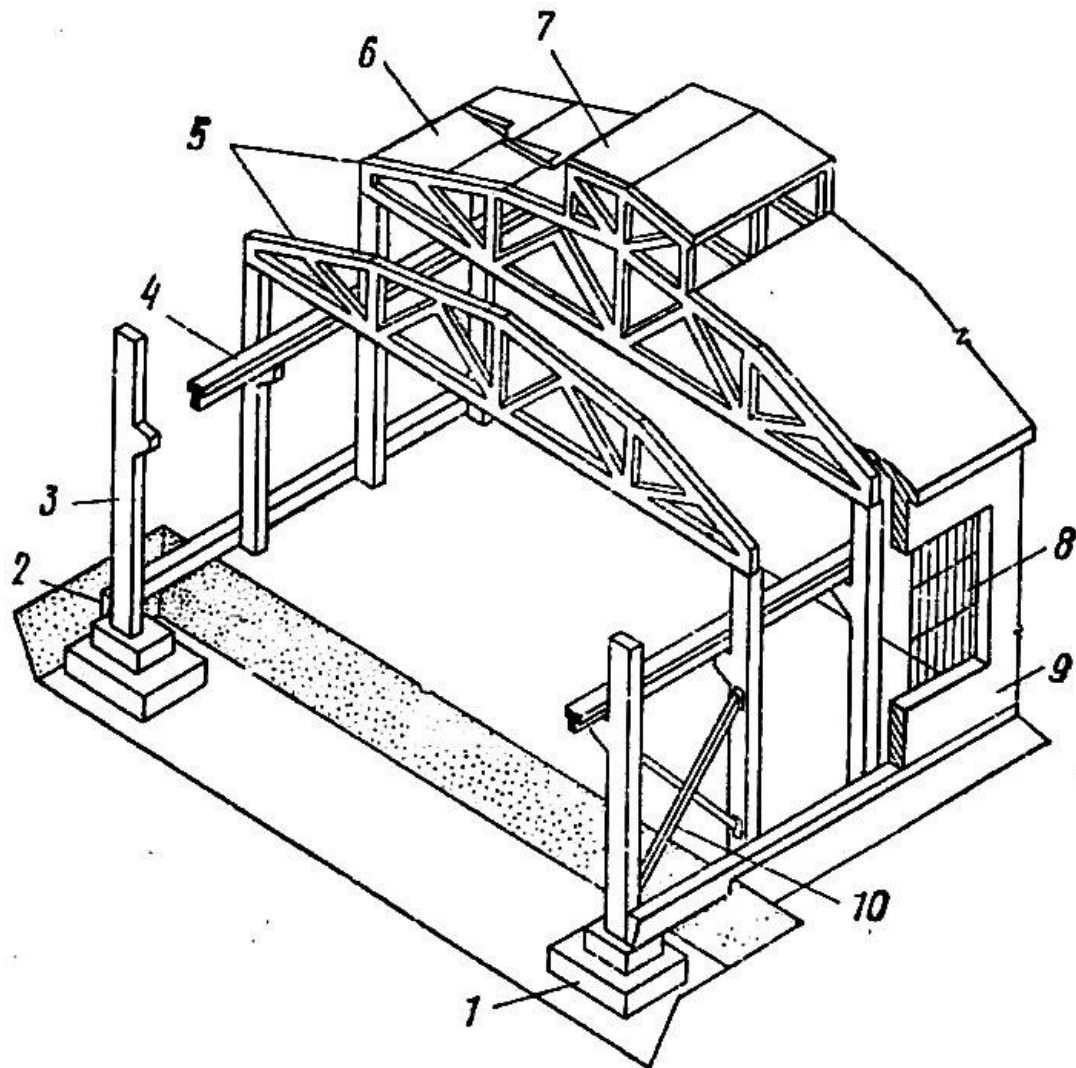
Фрагмент будівлі, виконаної в залізобетонному каркасі:
